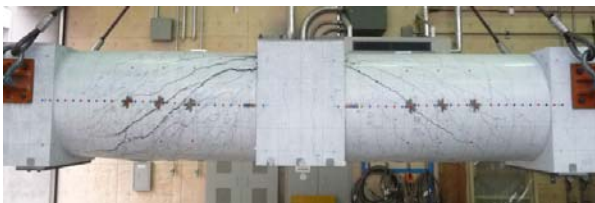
実験終了後のひび割れ状況（試験体1）
